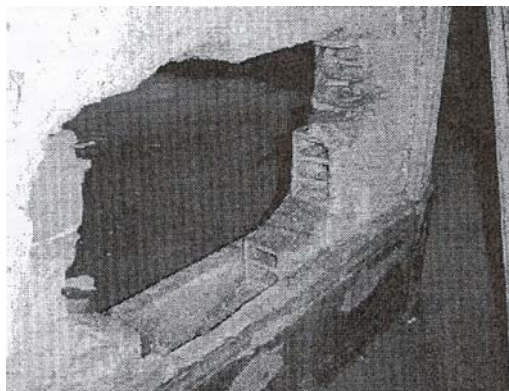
Edifício principal – alvenaria divisória em tijolo furado, assentado em fiada de meia vez.
